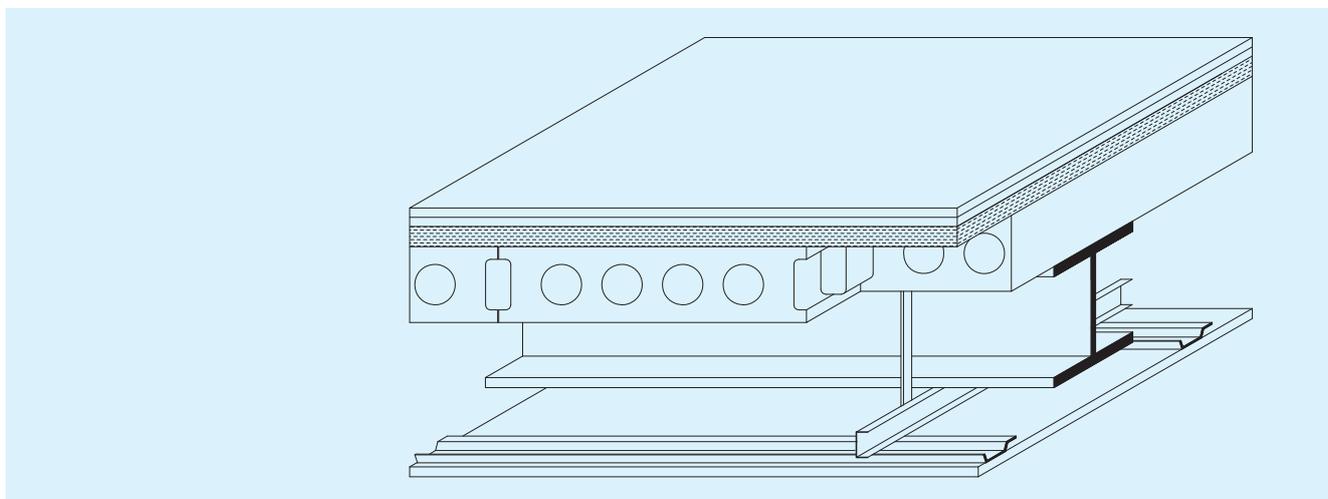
Типовая конструкция перекрытия, обеспечивающая улучшенные звукоизоляционные характеристики
